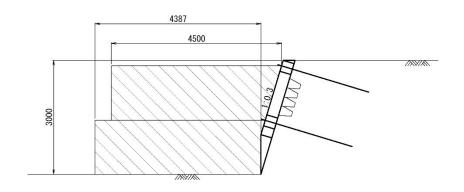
重力式コンクリート擁壁工法、鉄筋コンクリート擁壁工法の施工スペースの目安
